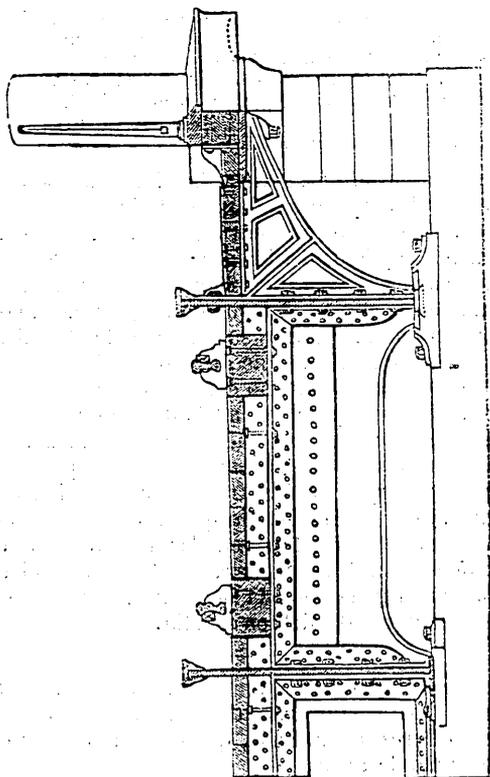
ª - Mitad del corte transversal del puente sobre el canal de Escant. - Escala de 1:1000.
